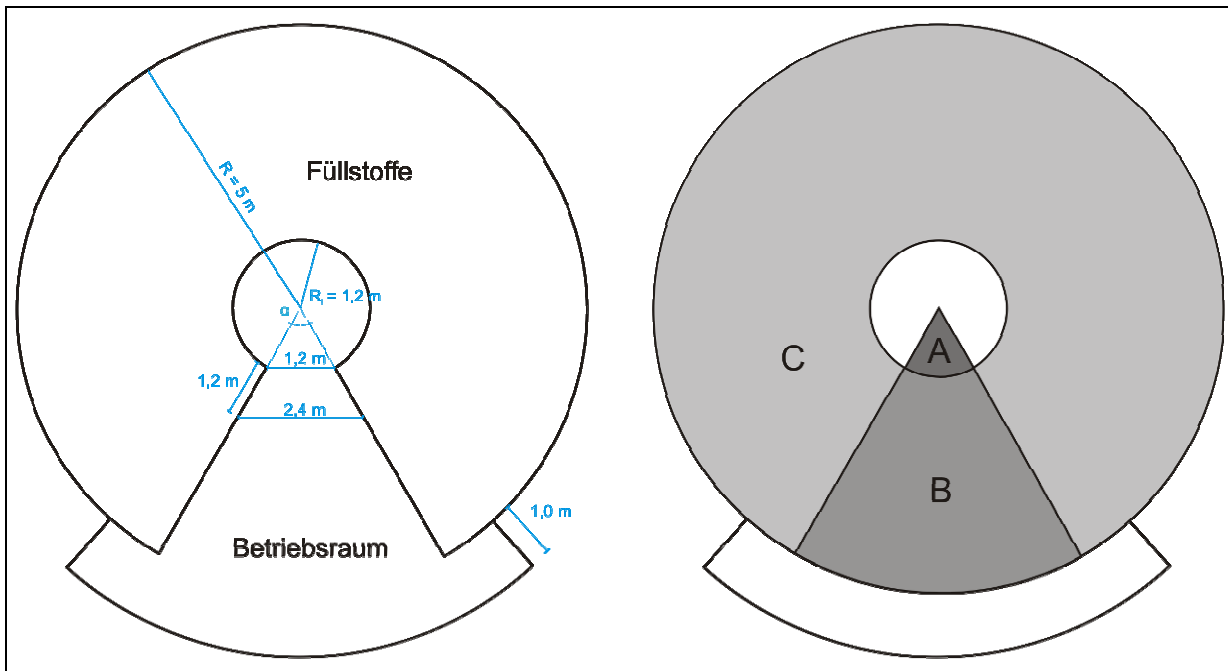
Lageplan des Tropfkörpers der Kläranlage Hoetmar (links), Flächen zur Volumenberechnung (rechts)
